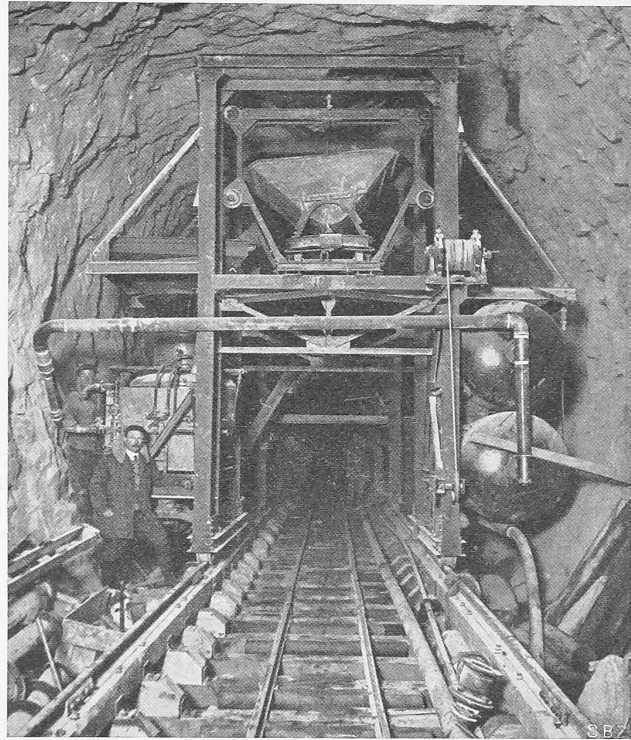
Beton-Pump-Installation System Ingersoll-Joney.
